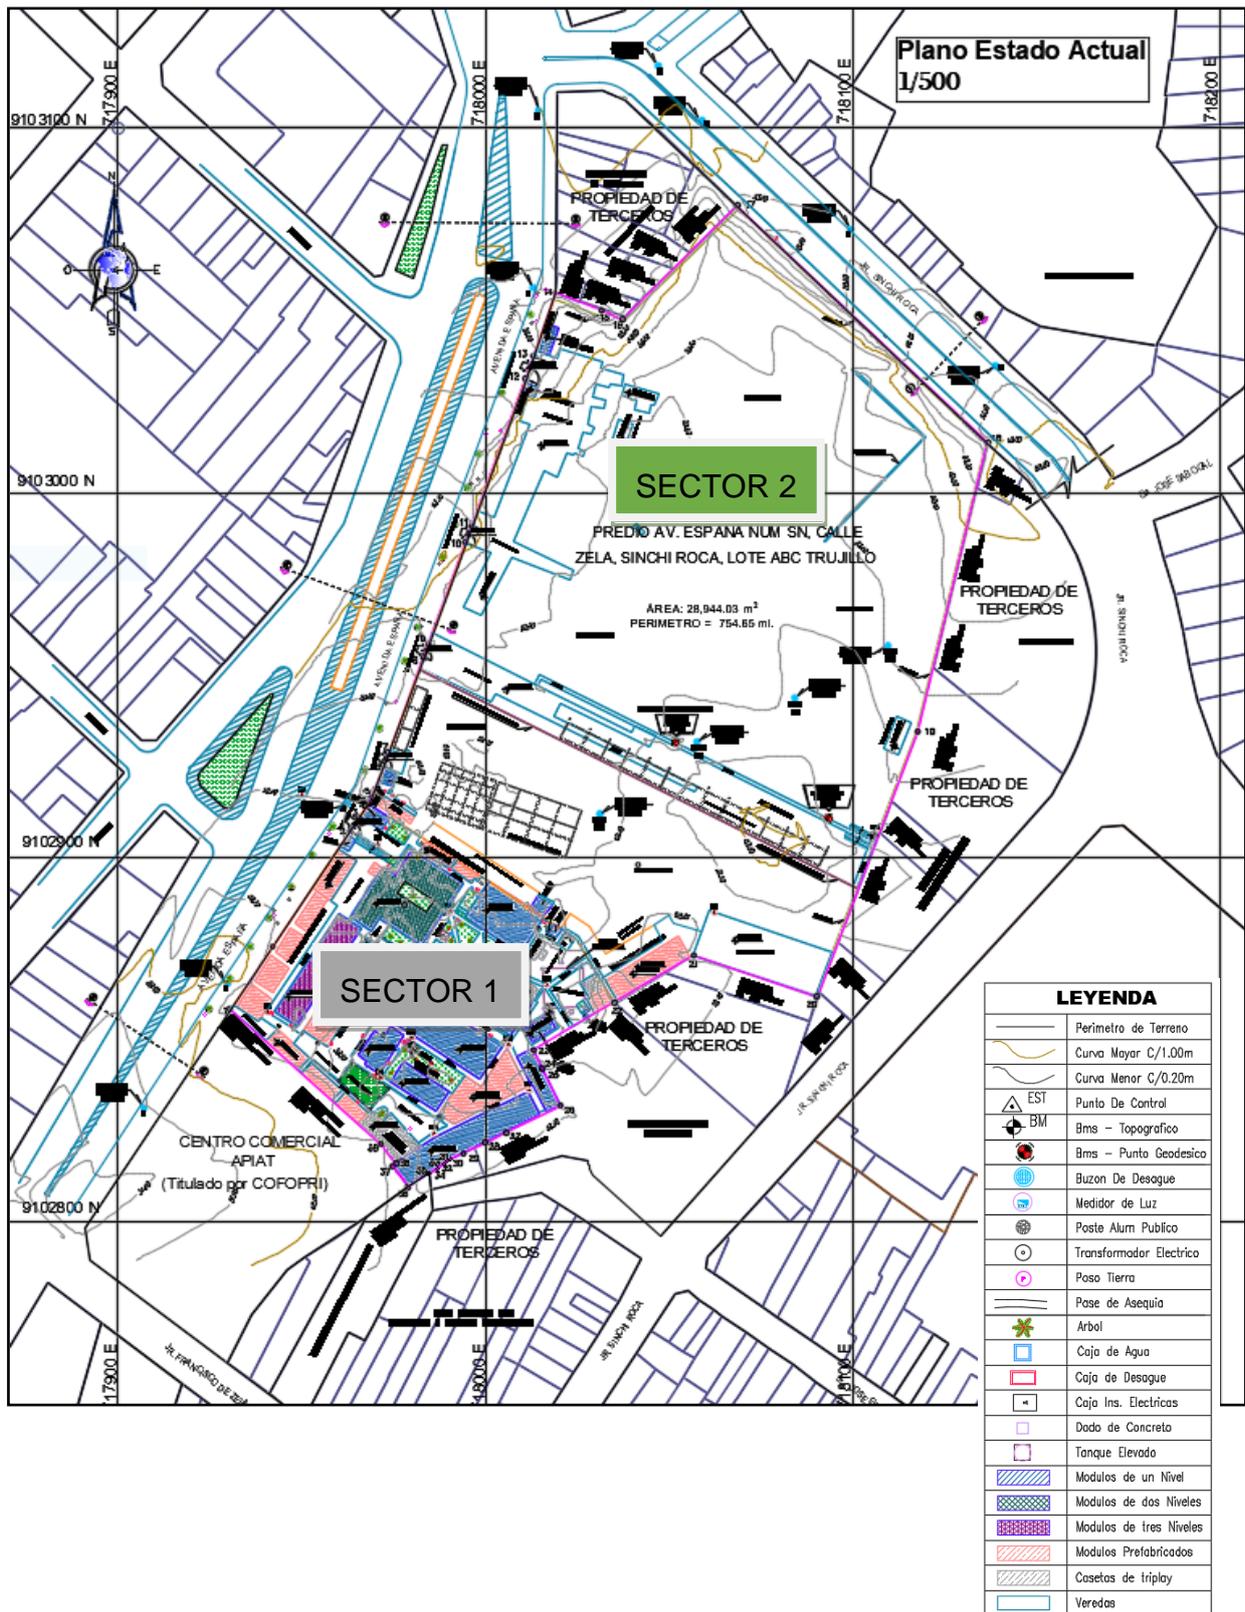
Plano de Sectores del predio y su Estado Actual
